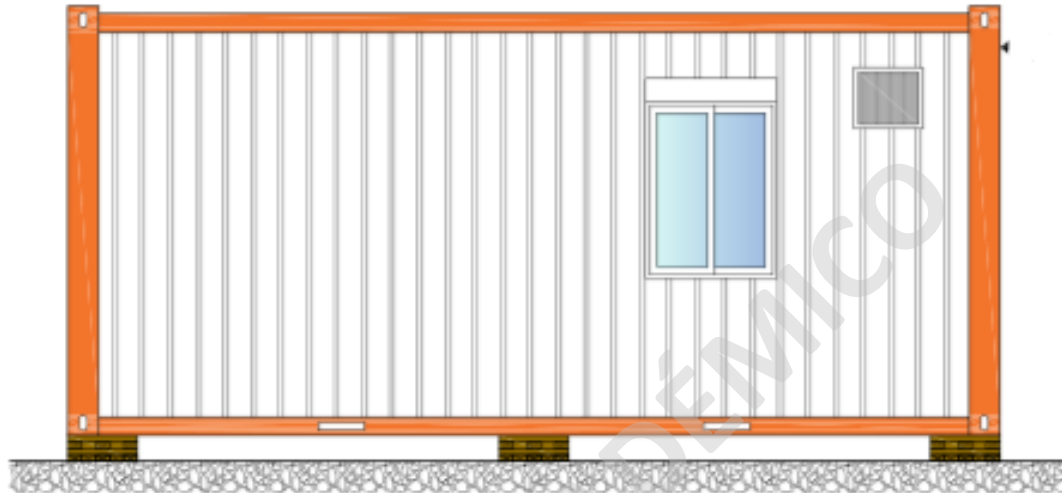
Detalle de anclaje tipo de sala eléctrica
